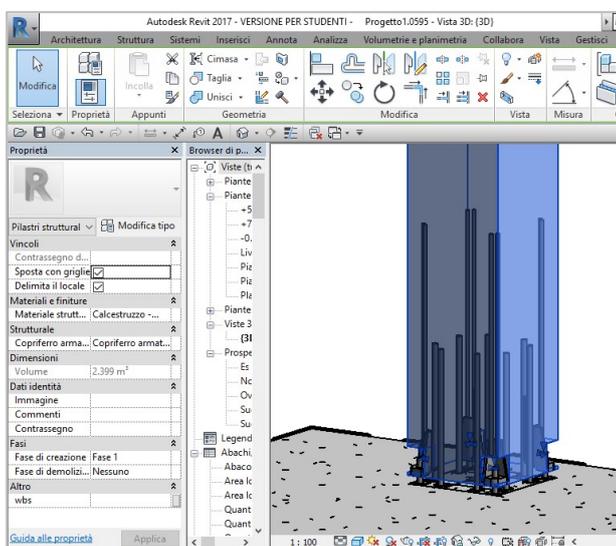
Dettaglio connessioni strutturali plinto-pilastro; inserimento delle "scarpe per pilastri HPKM30" nel modello Revit.
